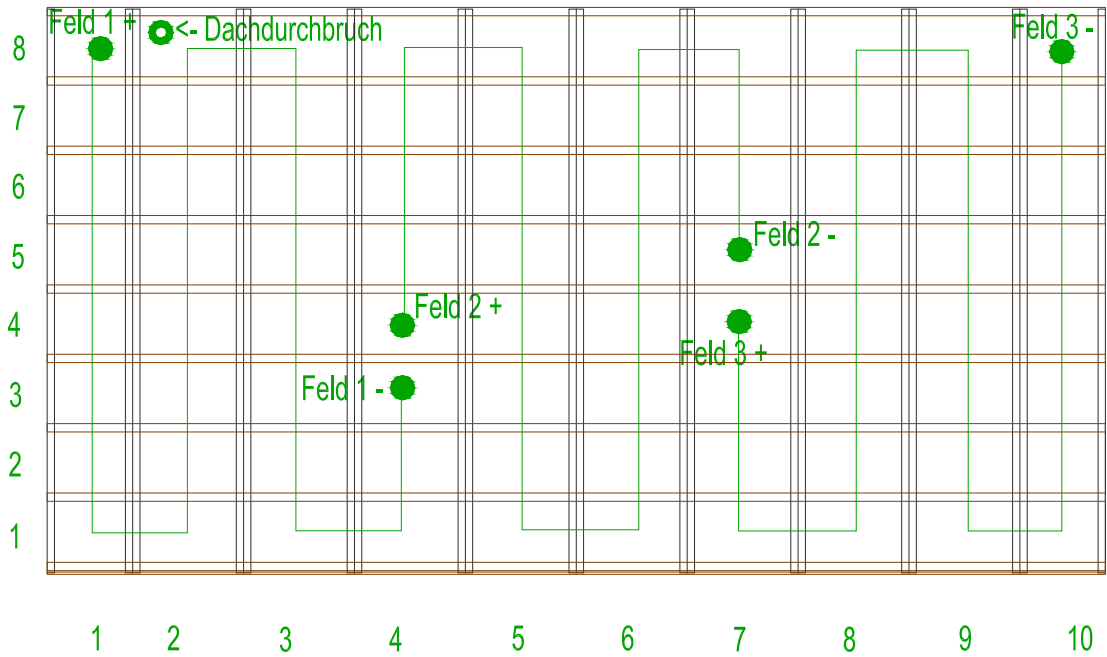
Exemple d'un plan de câblage; version câblage « verticale »
